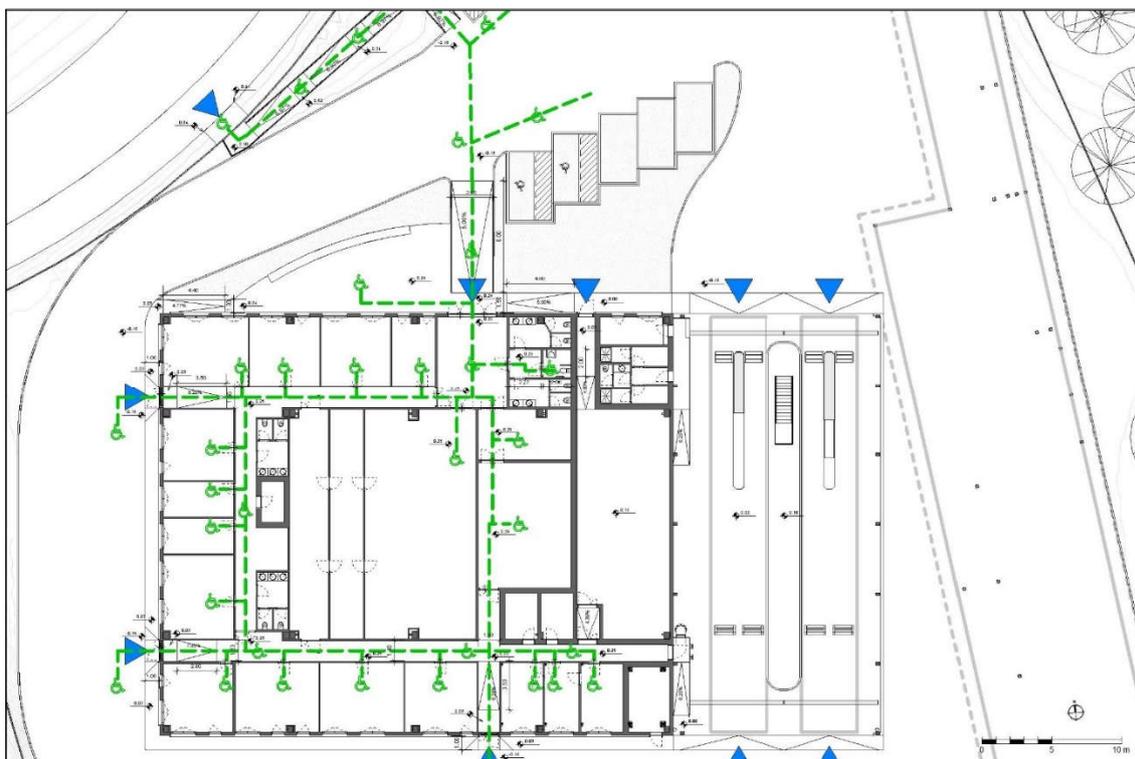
Planimetria con indicazione dei percorsi ed elementi ad eliminazione delle barriere architettoniche
